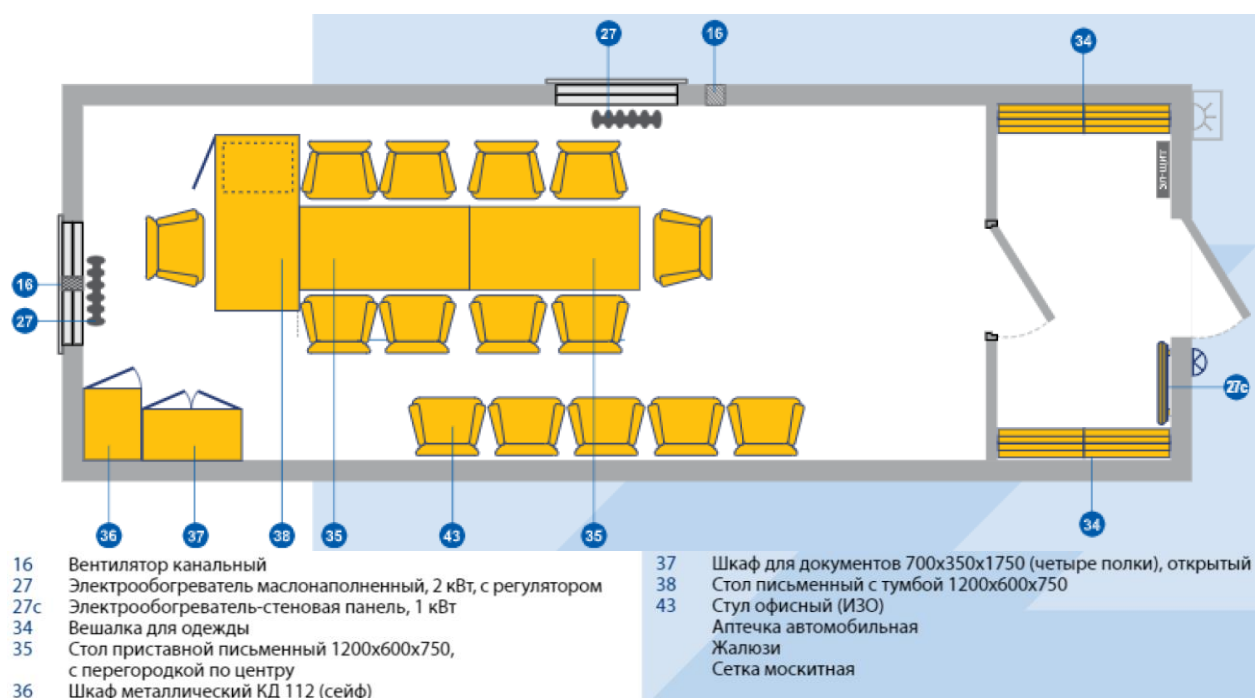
Мобильное здание Ермак 804.1 (Группа «Ермак»)
